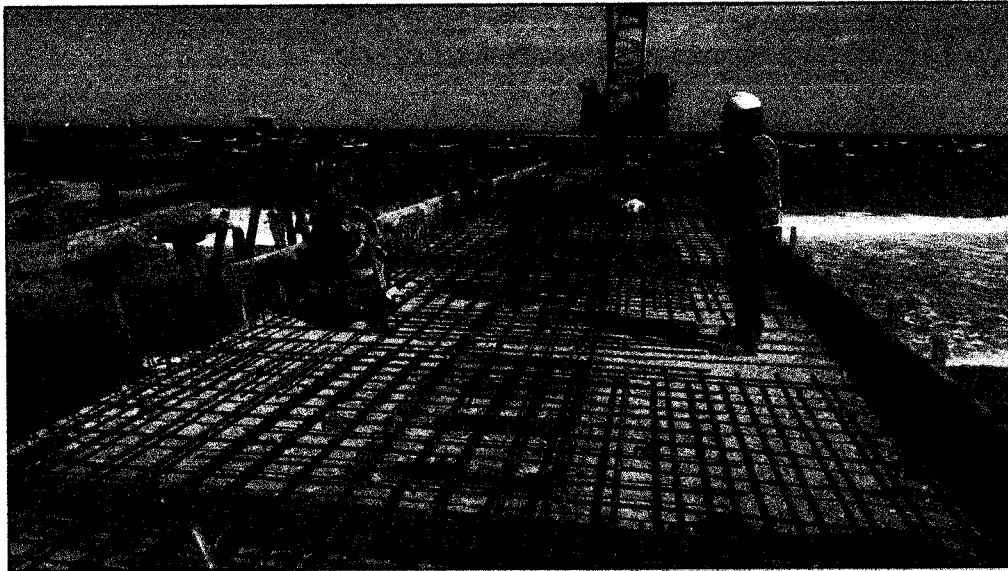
Desencofrado de juntas longitudinales y transversales.
